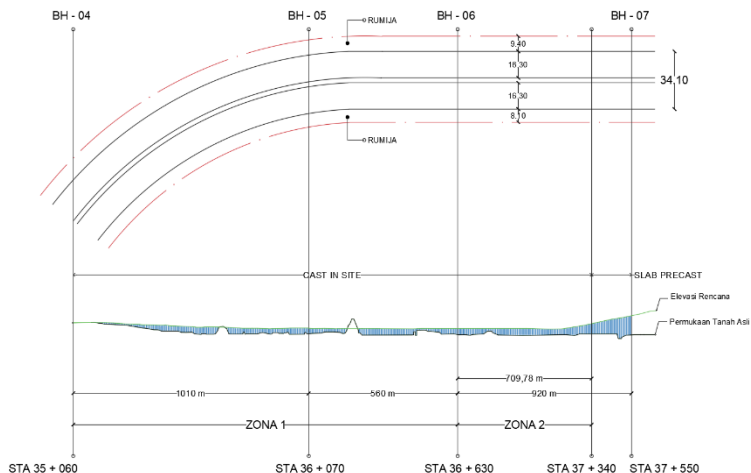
2 Denah lokasi BH - 04 s.d BH - 07
